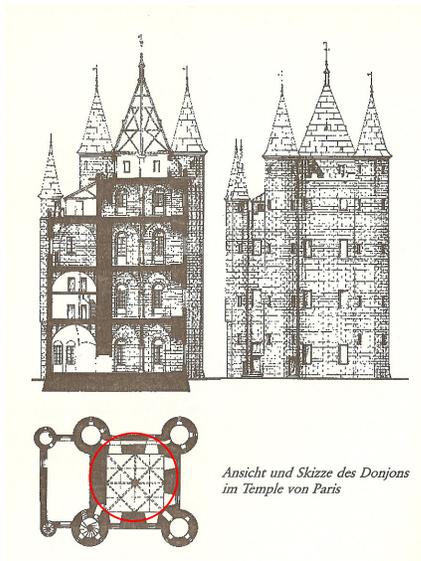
Grundrissmuster im Templer-Hauptgebäude
